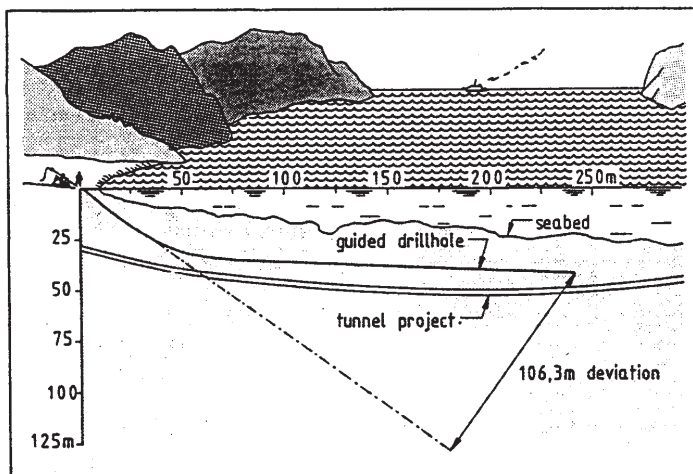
Undersøkelser i forbindelse med planlegging av undersjøisk tunnel.
